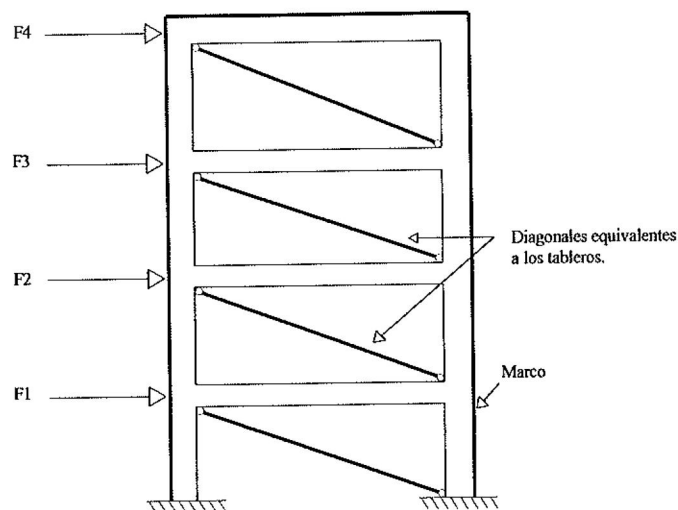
Diagonales en compresión equivalentes a muros de mampostería confinados por vigas y columnas, cuando están sujetos a cargas laterales.
